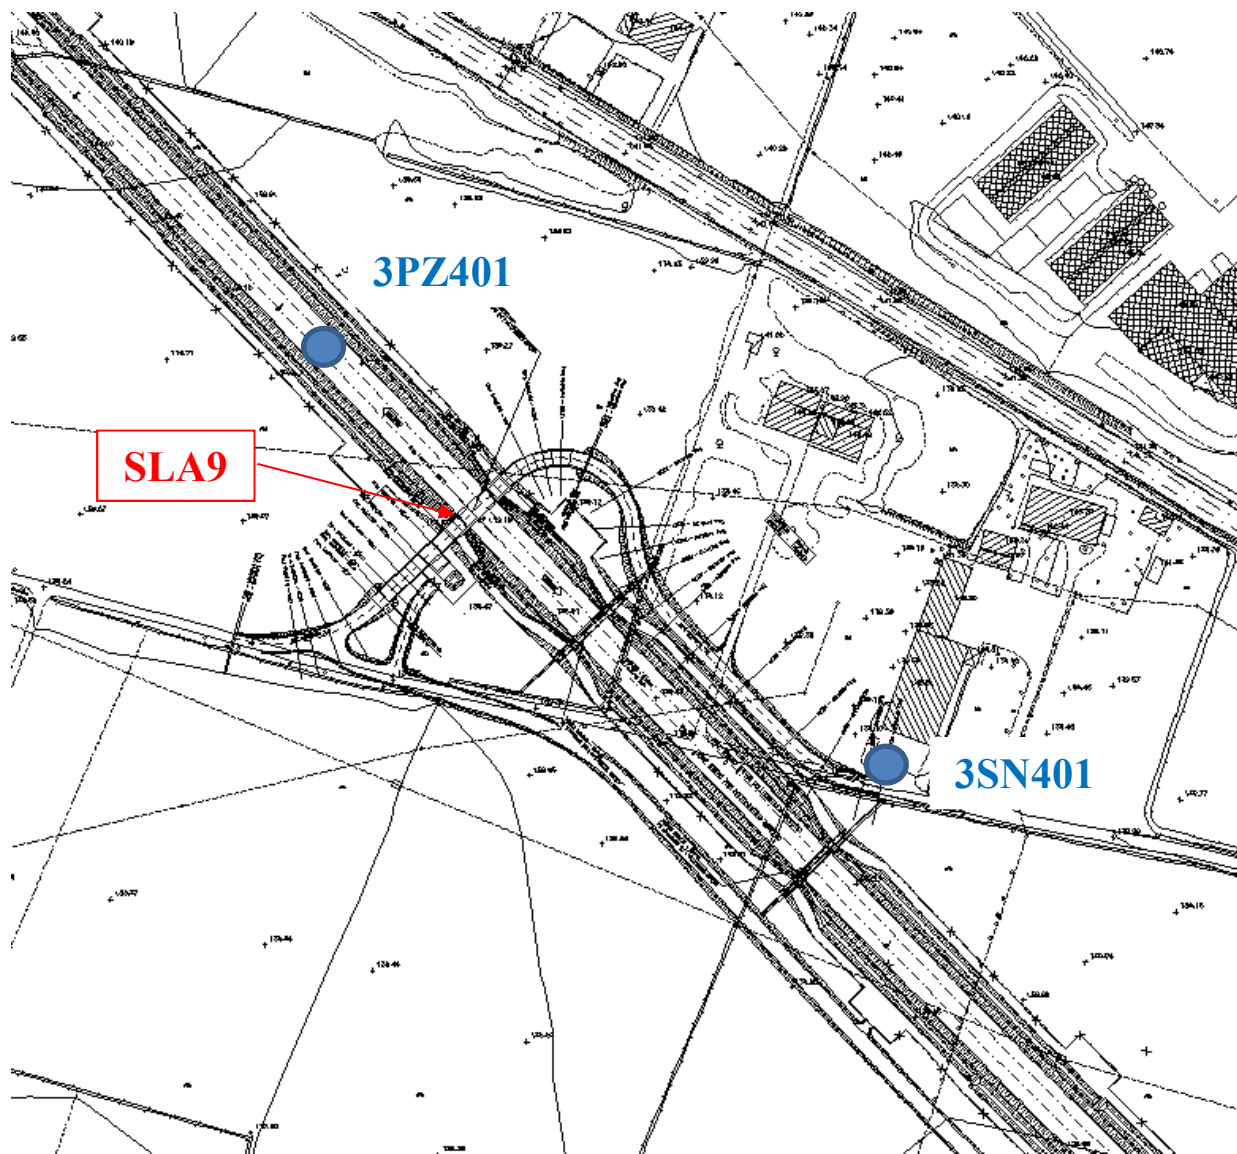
Stralcio planimetrico con ubicazione dei sondaggi
